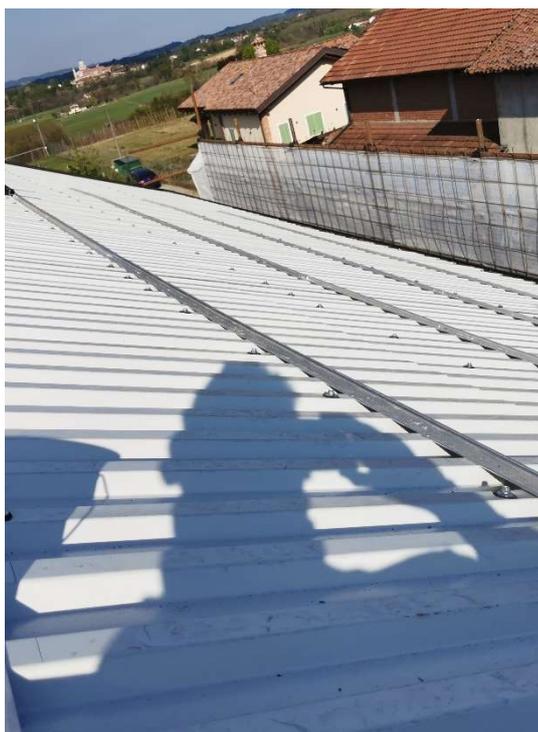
Posa lamiera e profili in alluminio per installazione impianto fotovoltaico su copertura
